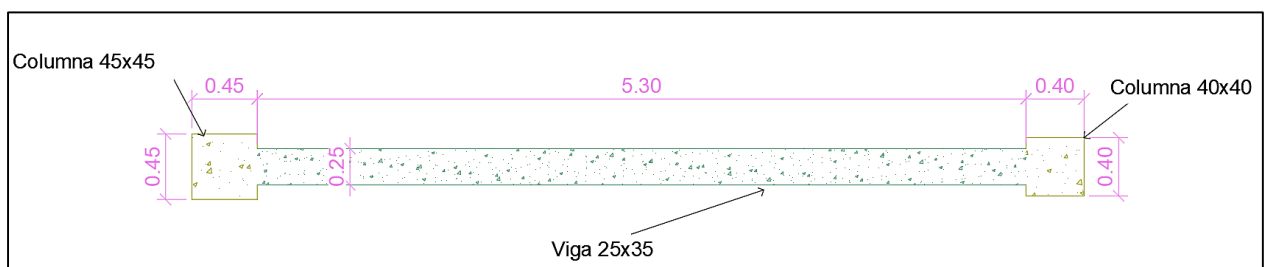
Pórtico seleccionado, vista en planta. Viga y Columnas F7 y F9
